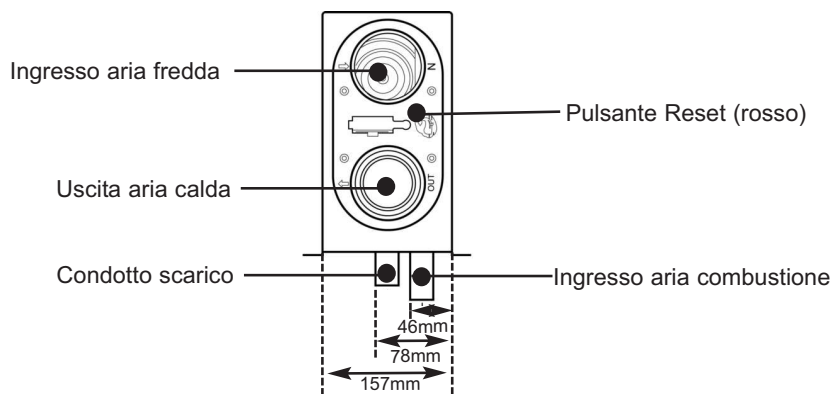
Installazione all'interno – Vista anteriore - SH2202 o SC2202
